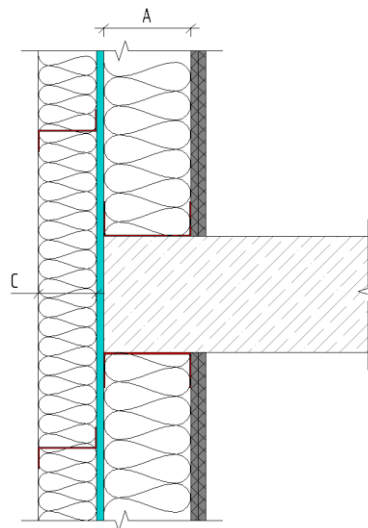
Схеми вузла спирання ПСК на залізобетонні плити перекриття.
